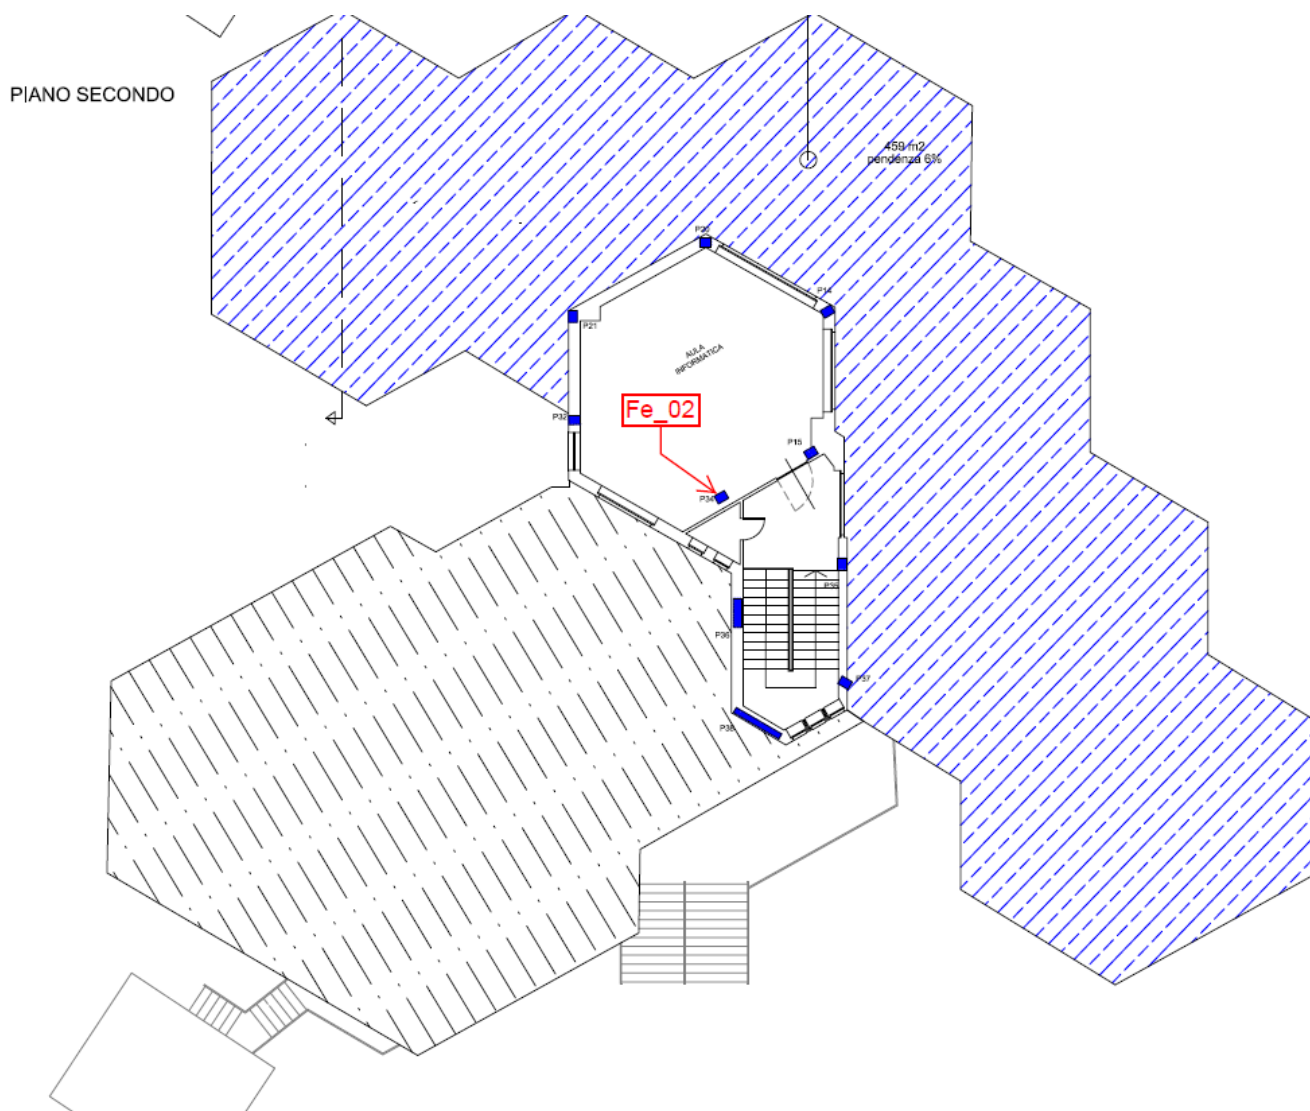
Localizzazione delle posizioni dei prelievi - plesso B- piano secondo
